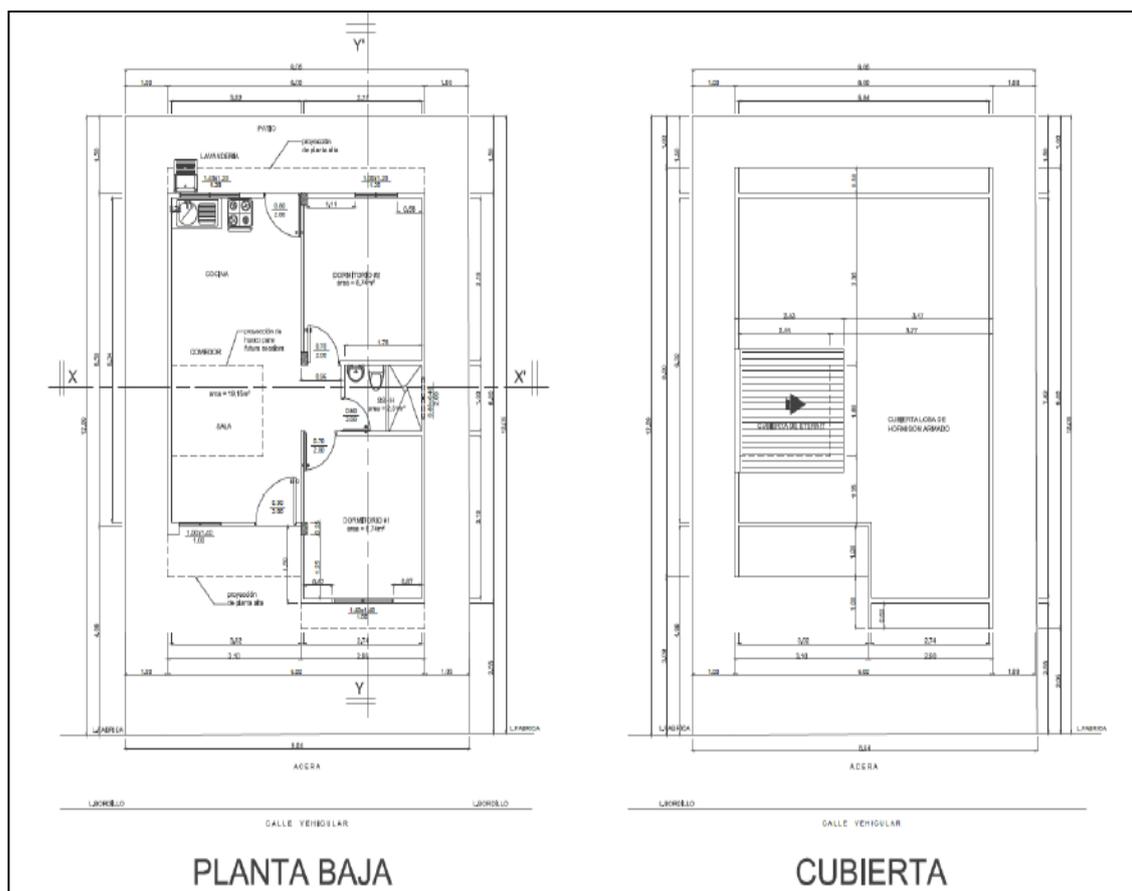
Modelo de Vivienda estándar para Plan Habitacional
